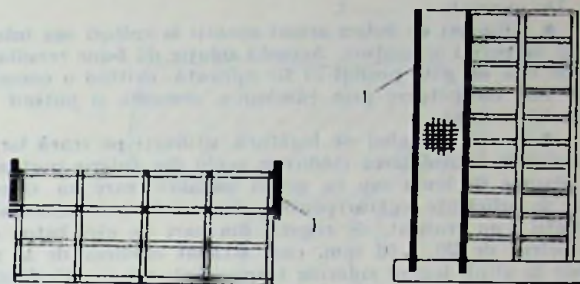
Consolidarea structurilor de beton armat cu elemente suplimentare (diafragme adiționale); (după N. Ignatiev, Sofia [11]; 1 — diafragmă adițională.
